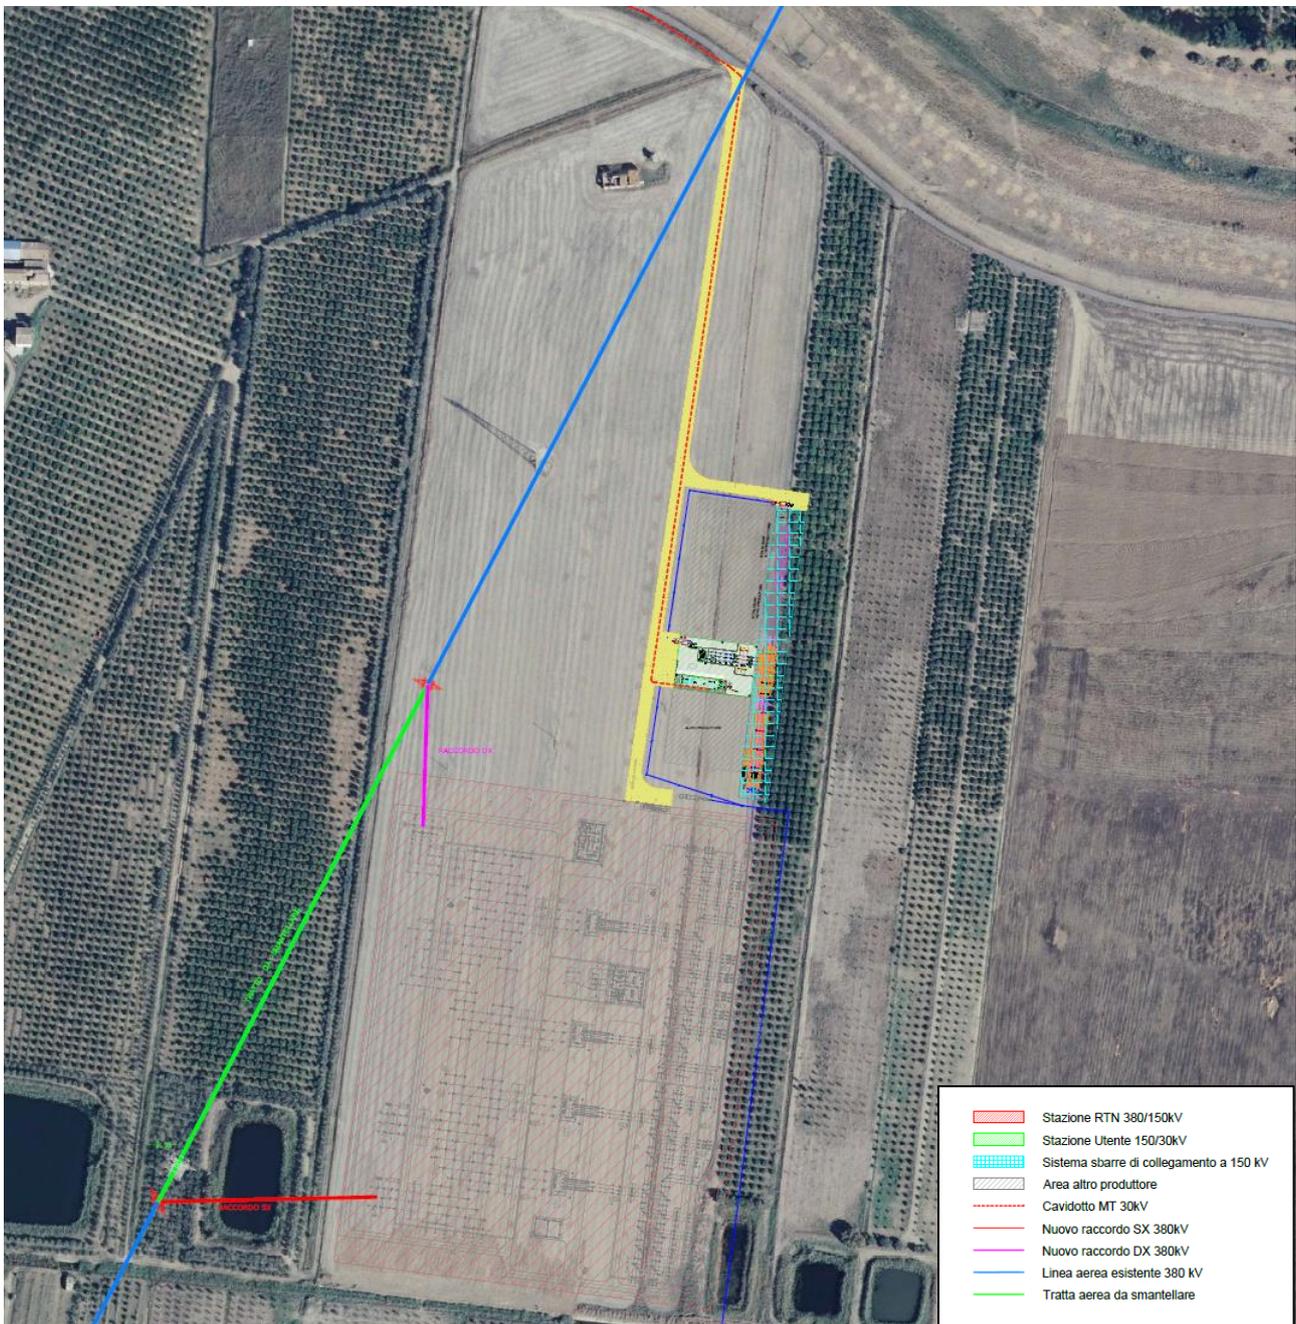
Lay out generale Impianto di Utente e Impianto di Rete
